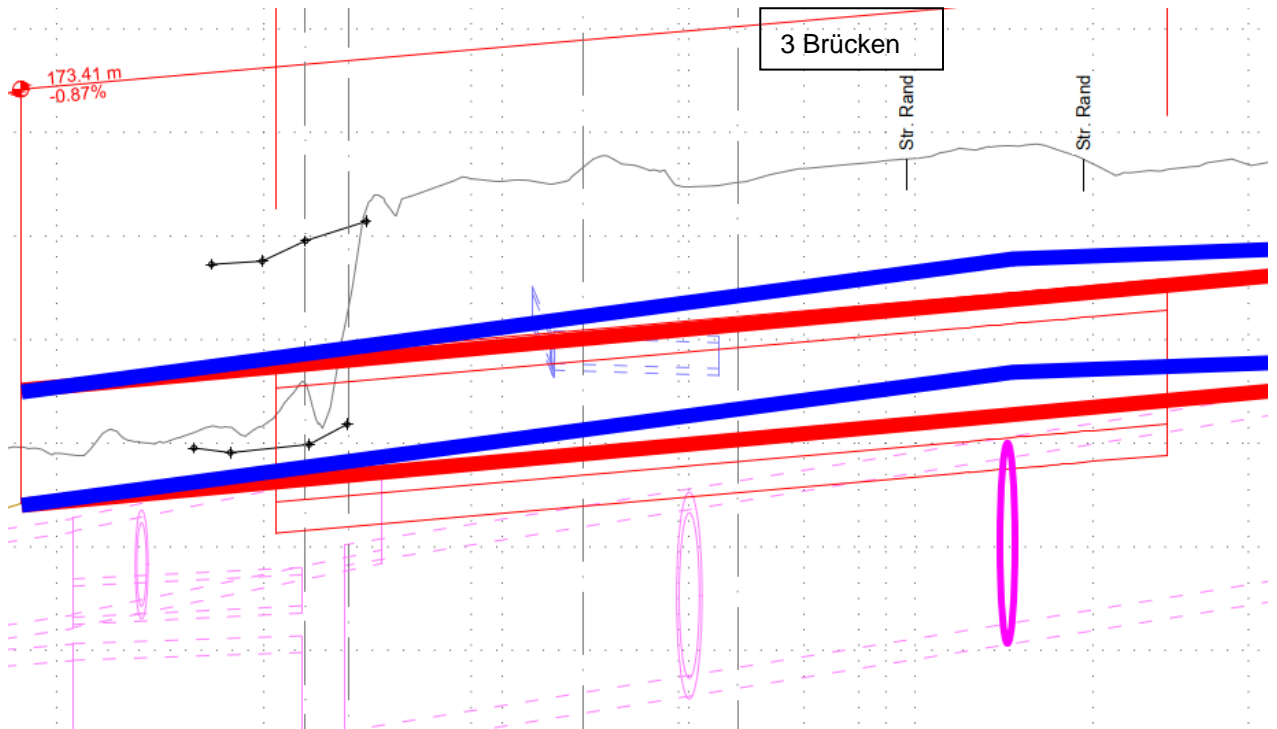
Ausschnitt Arbeitsplan Längenprofil Querung Brückenplan und anschliessender Kantonsstrasse, rot: Variante 1, blau: Variante 2
